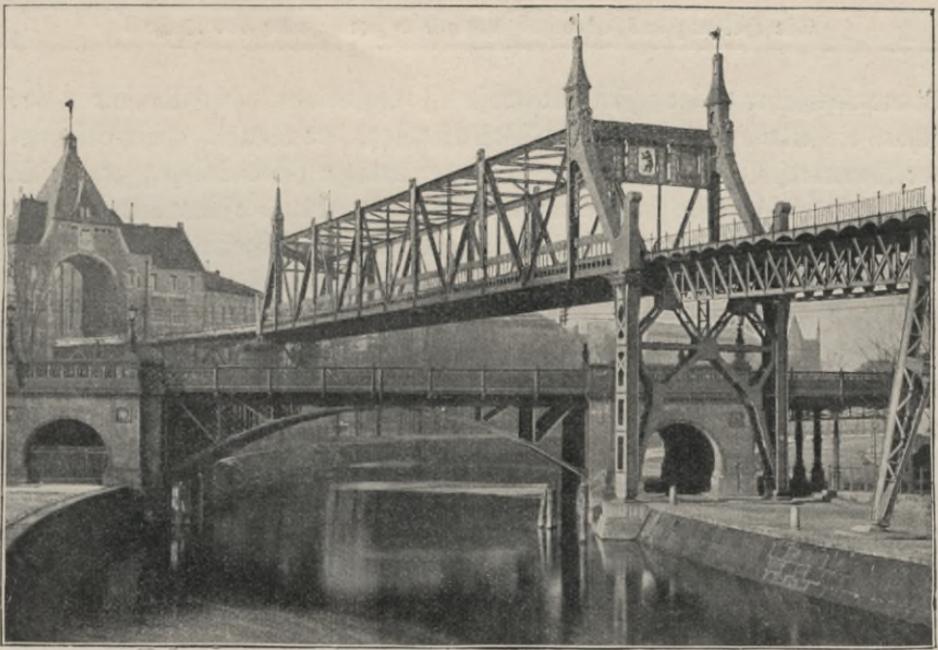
Im Zeichen des Verkehrs am Berliner Landwehrkanal: Kanal, Straße, Dampf-
